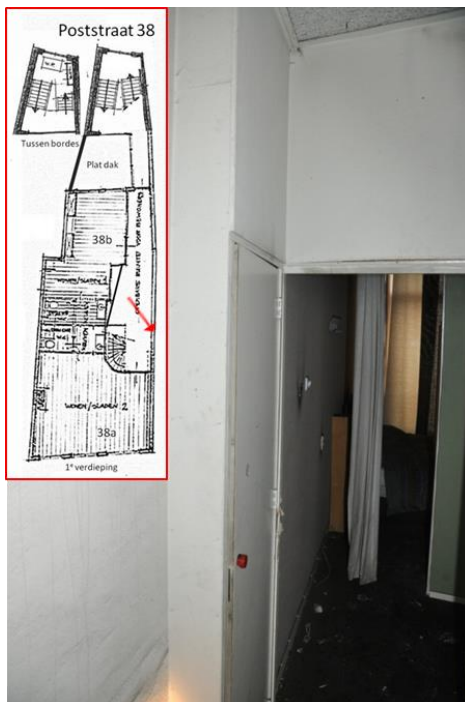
, gang tweede bouwlaag, dikte voorzetwand circa 20 cm. Links originele wandconstructie.
